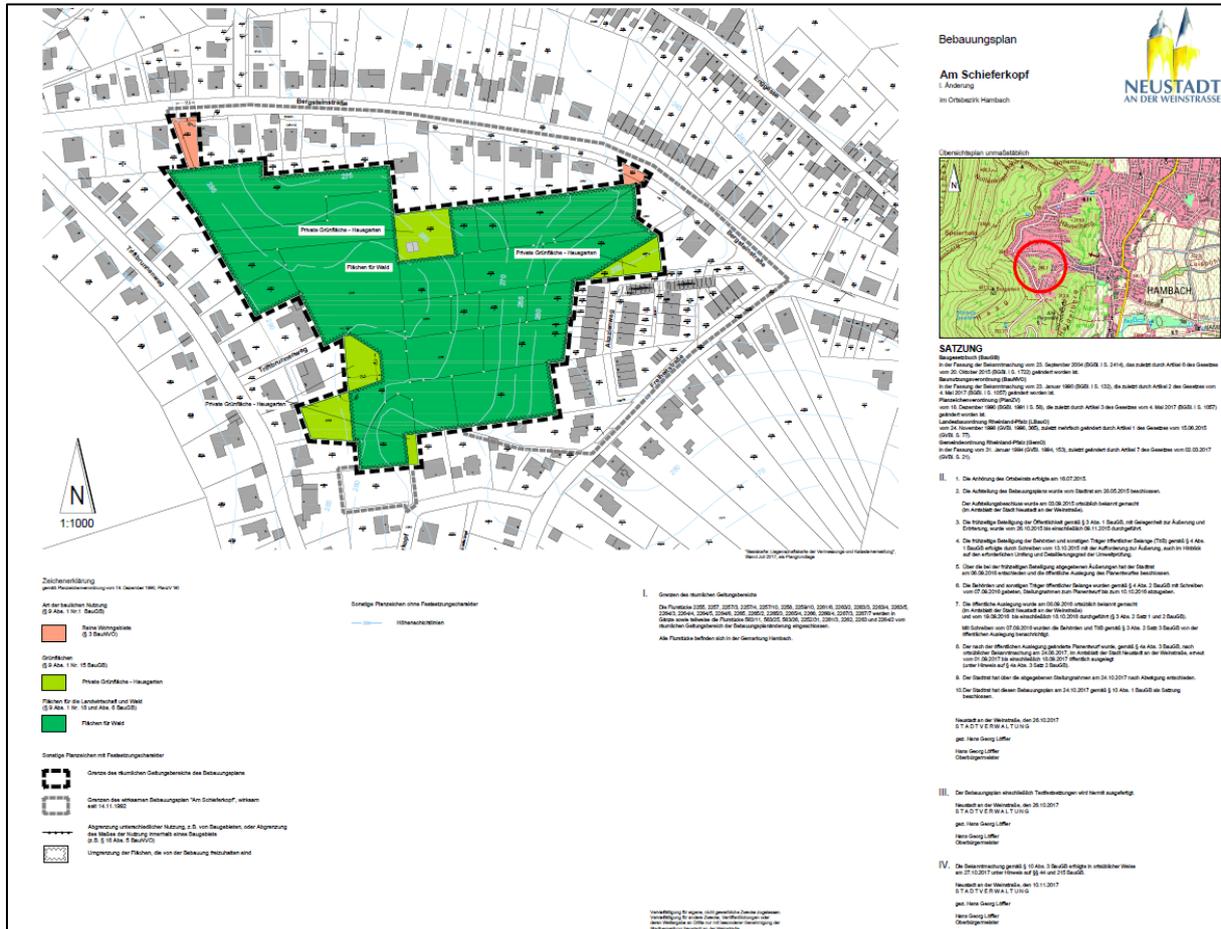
Bebauungsplan „Am Schieferkopf 1. Änderung“<sup>9</sup>
